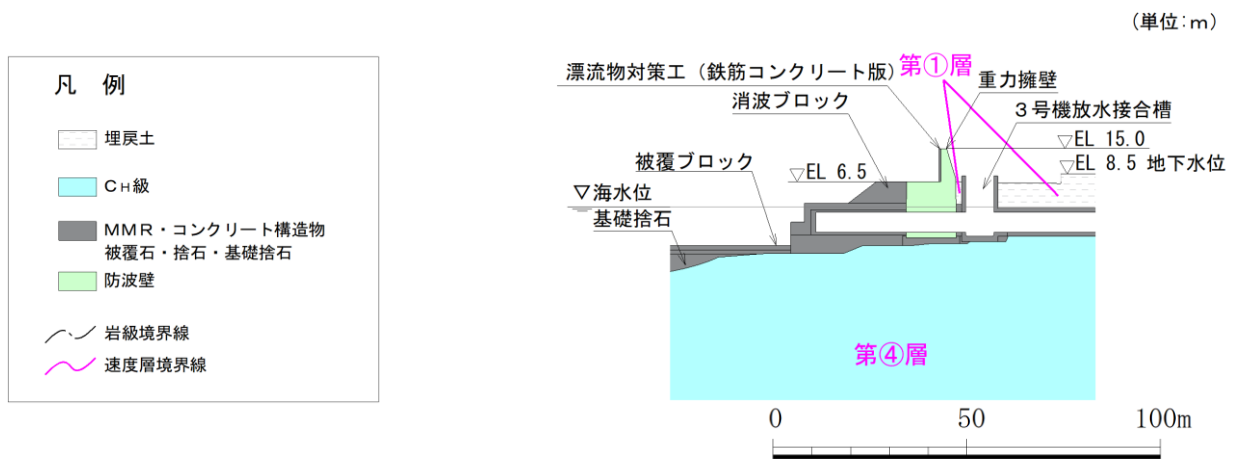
(3) 地質断面図 (防波壁 (波返重力擁壁) ③-③断面 (参考))
